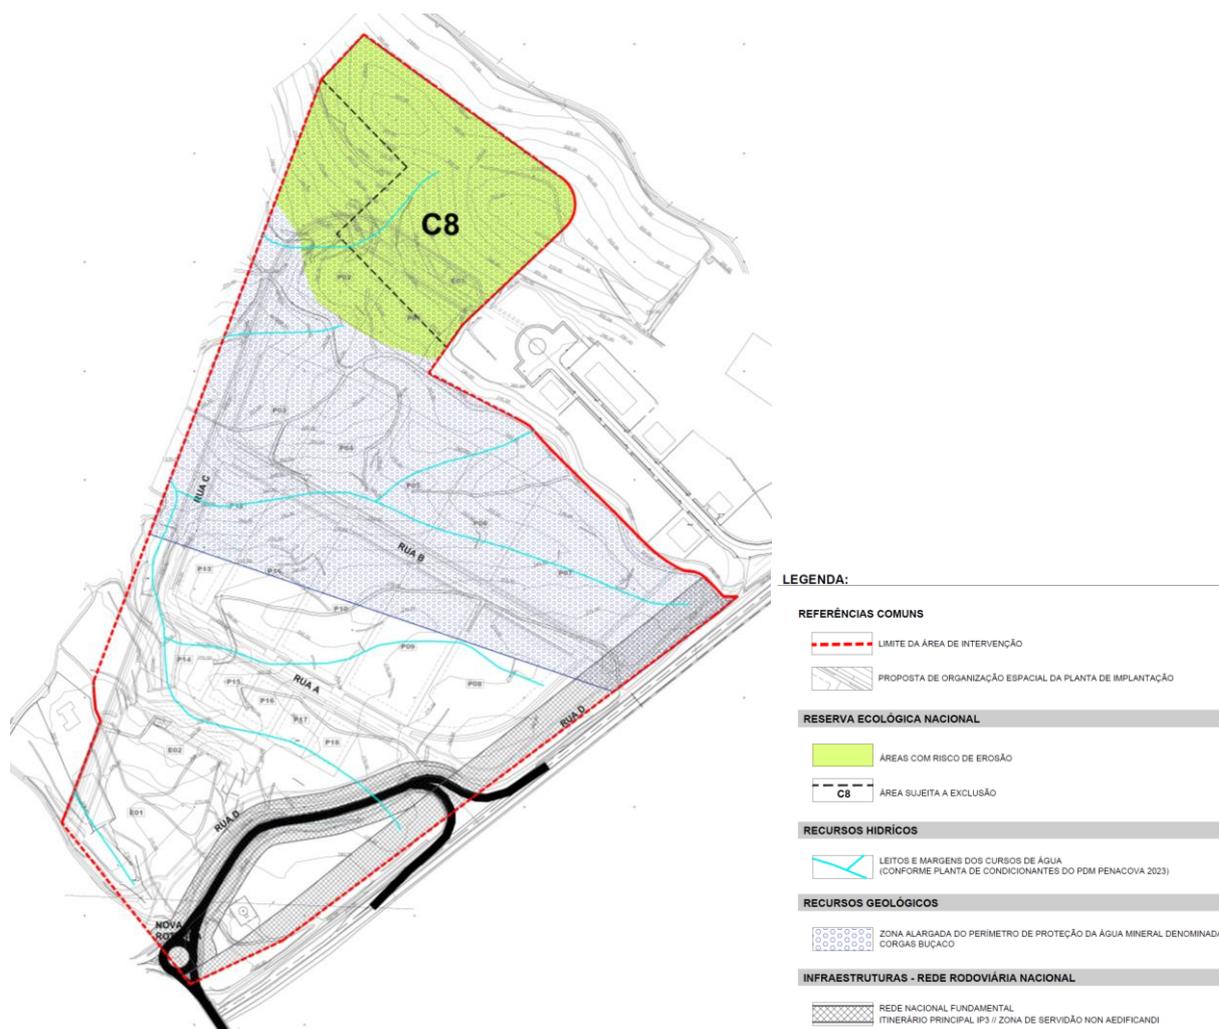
Planta de Condicionante do Plano de Pormenor da Ampliação da Zona Empresarial de Alagoa. 2024
